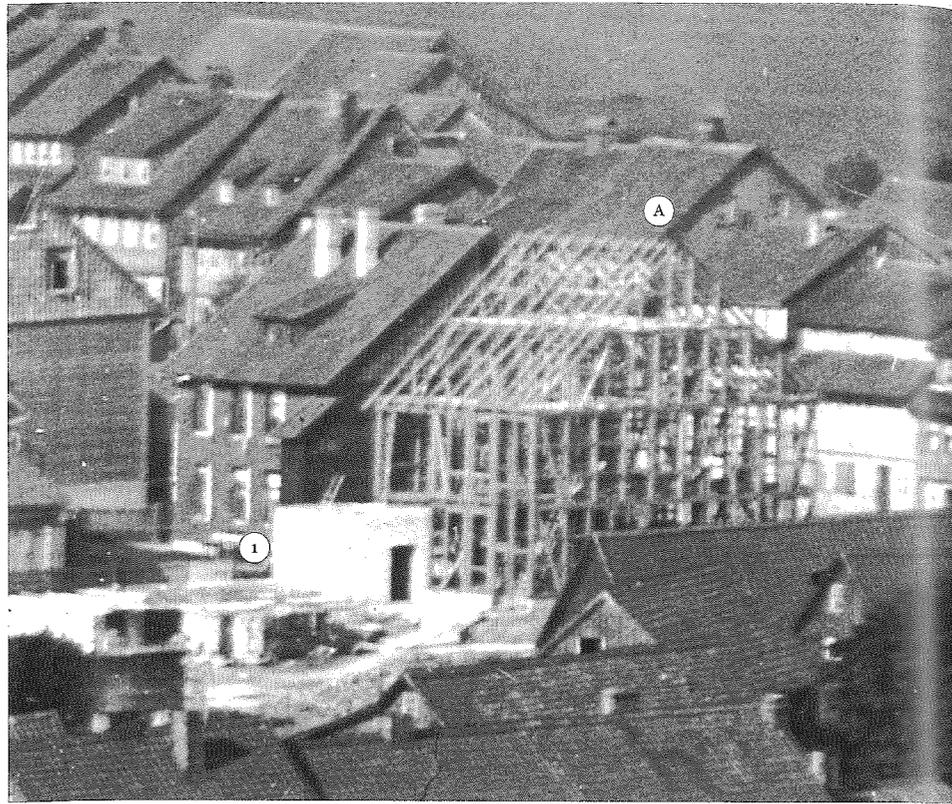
Das Haus Mühlenstraße 9 wird gebaut (aus Abb. 69).
